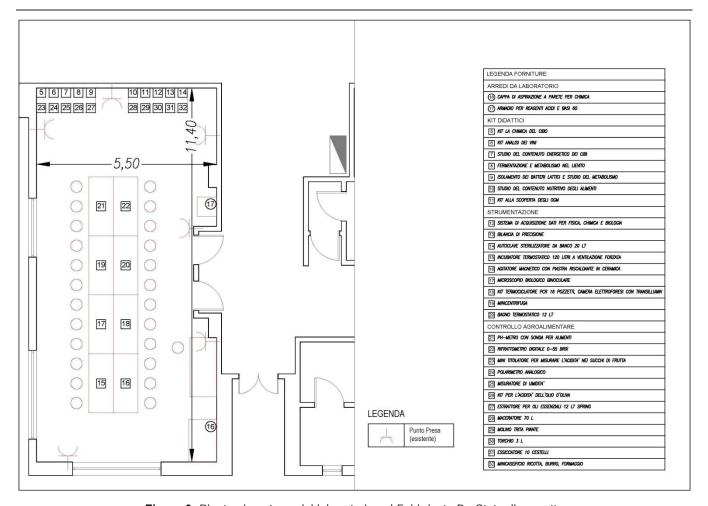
Pianta piano terra del laboratorio nel Fabbricato B - Stato di progetto
